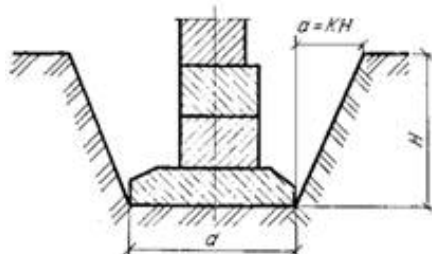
Схема поперечного сечения траншеи с откосами для фундамента
